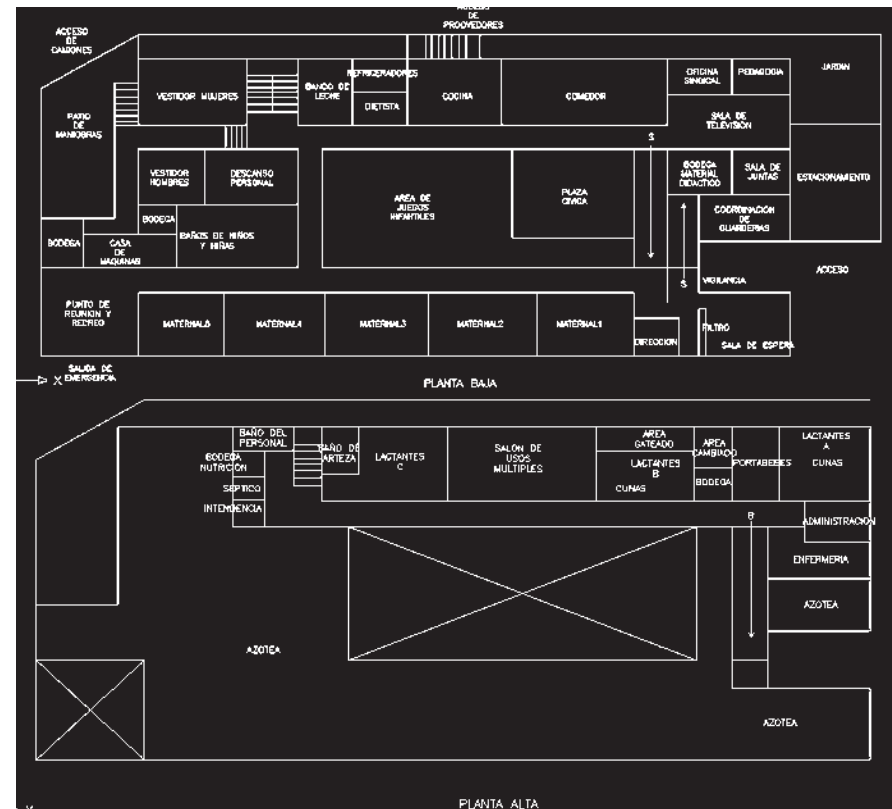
Croquis de las planta baja y alta de la Guardería del IMSS
